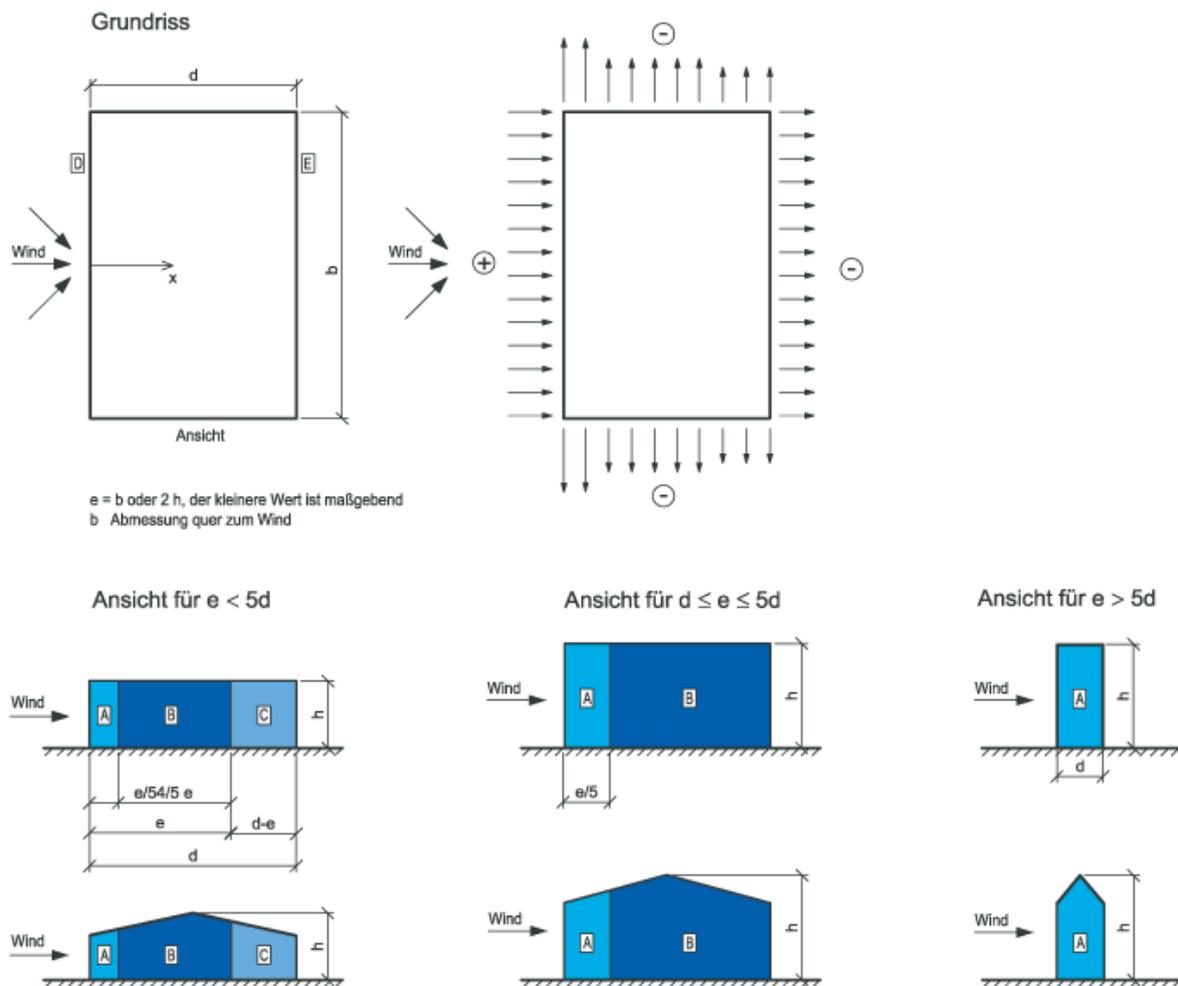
Ermittlung der Bereiche bei vertikalen Gebäudewänden
